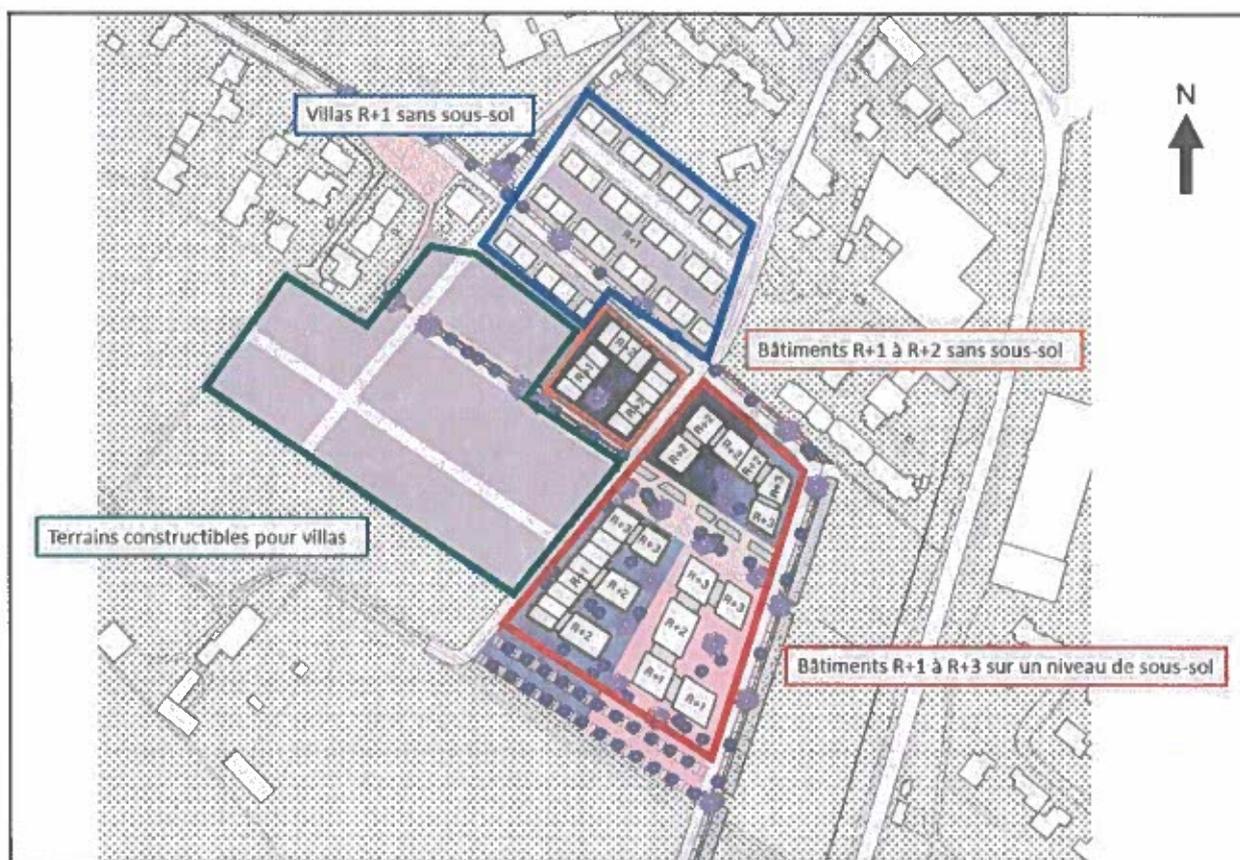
Extrait du plan de masse du projet (avec annotations)
